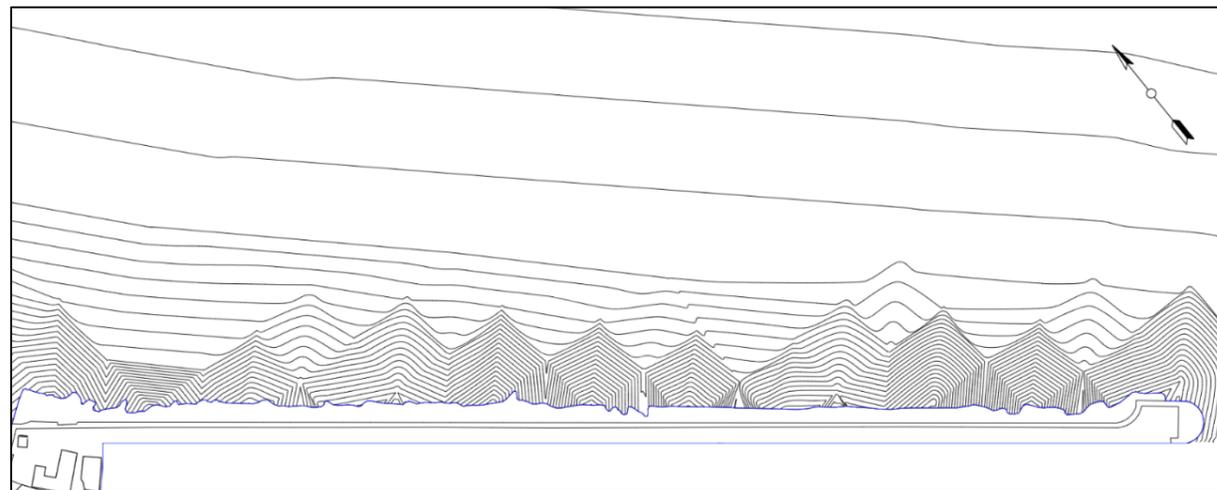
Batimetría a pie de estructura, incluye el manto de la estructura actual.
